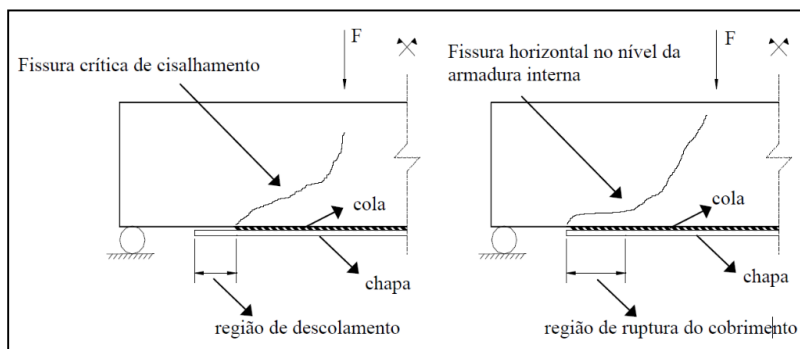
Modos de rotura prematura em vigas reforçadas com chapas de aço (REIS, 1998).
